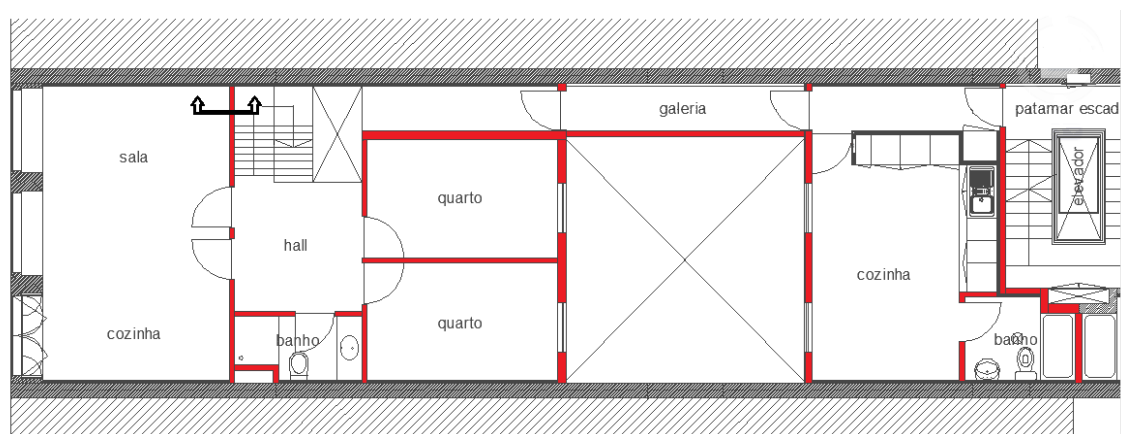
Marcação da zona de corte da parede divisória interior na planta (Adaptado das peças desenhadas do Edifício do Caso de Estudo)
